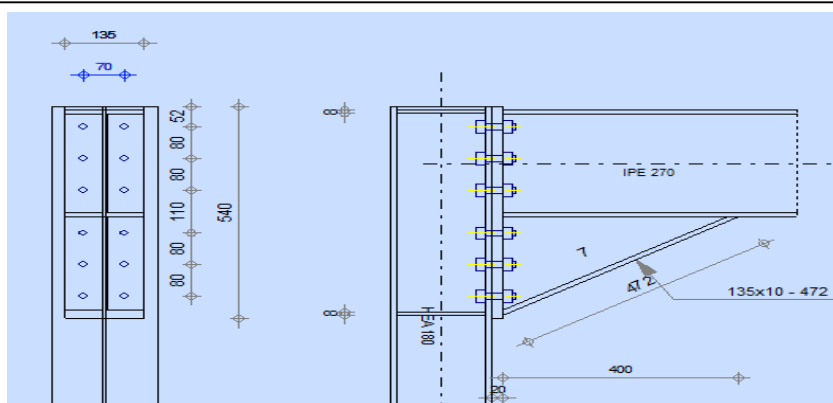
Détail sur l'assemblage poutre maitresse –poteau-plancher
